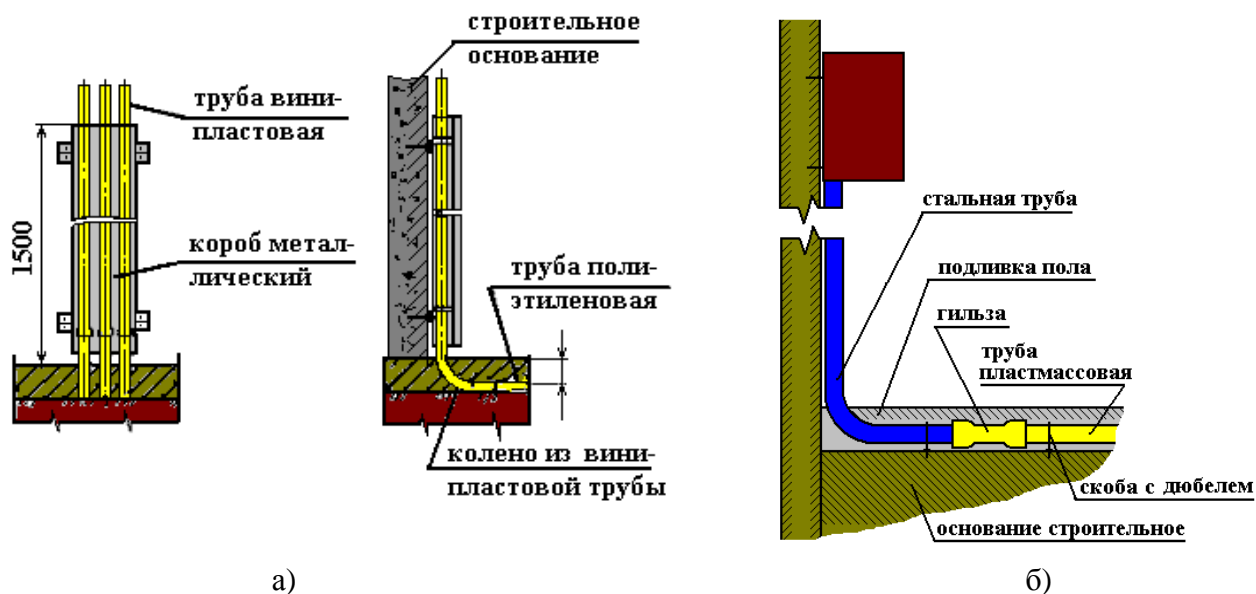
Защита пластмассовых труб: а) при подводе их к оборудованию металлическим коробом; б) при подводе их к оборудованию стальной трубой
